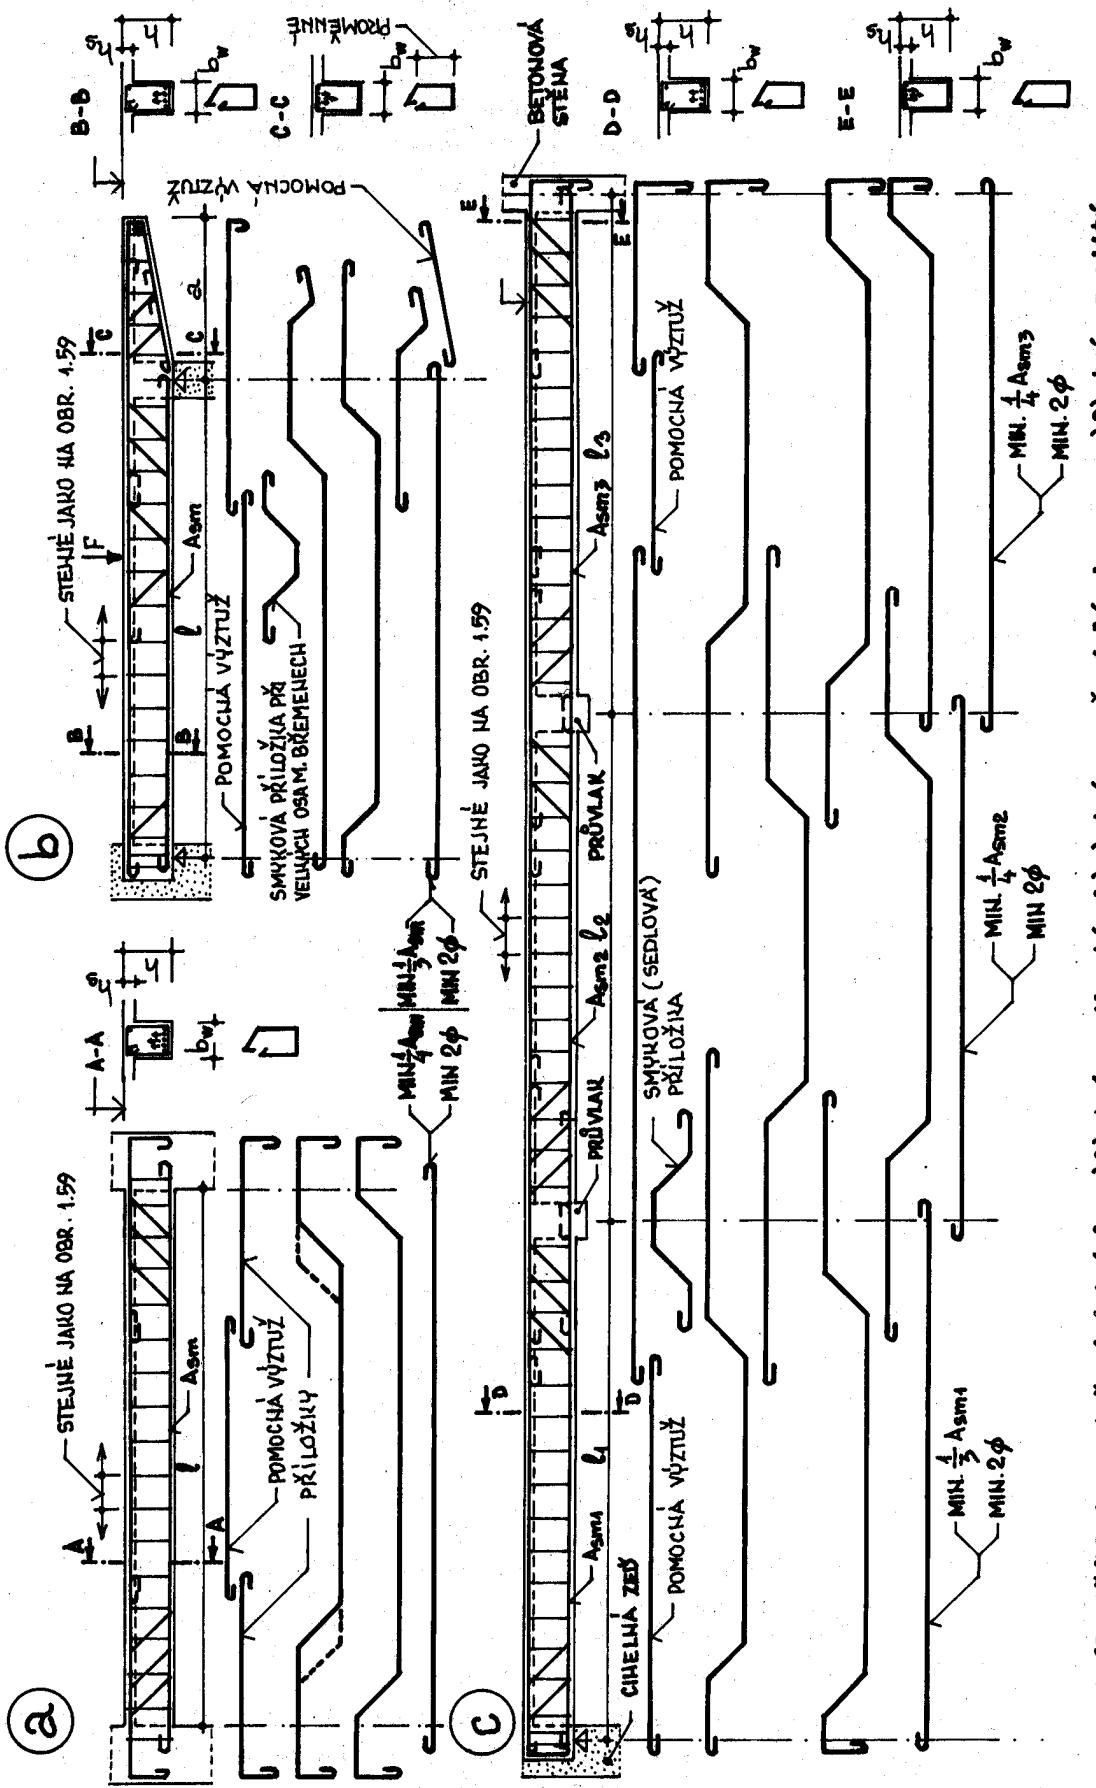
Výstuž v záloženém místě konstrukčního prvku
